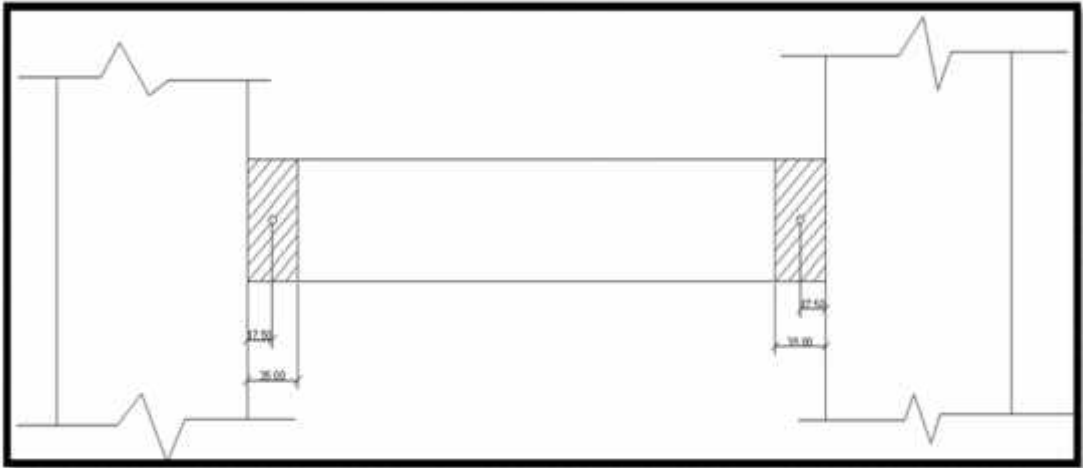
Rotulas plásticas en viga del tramo 2 del pórtico A-A
